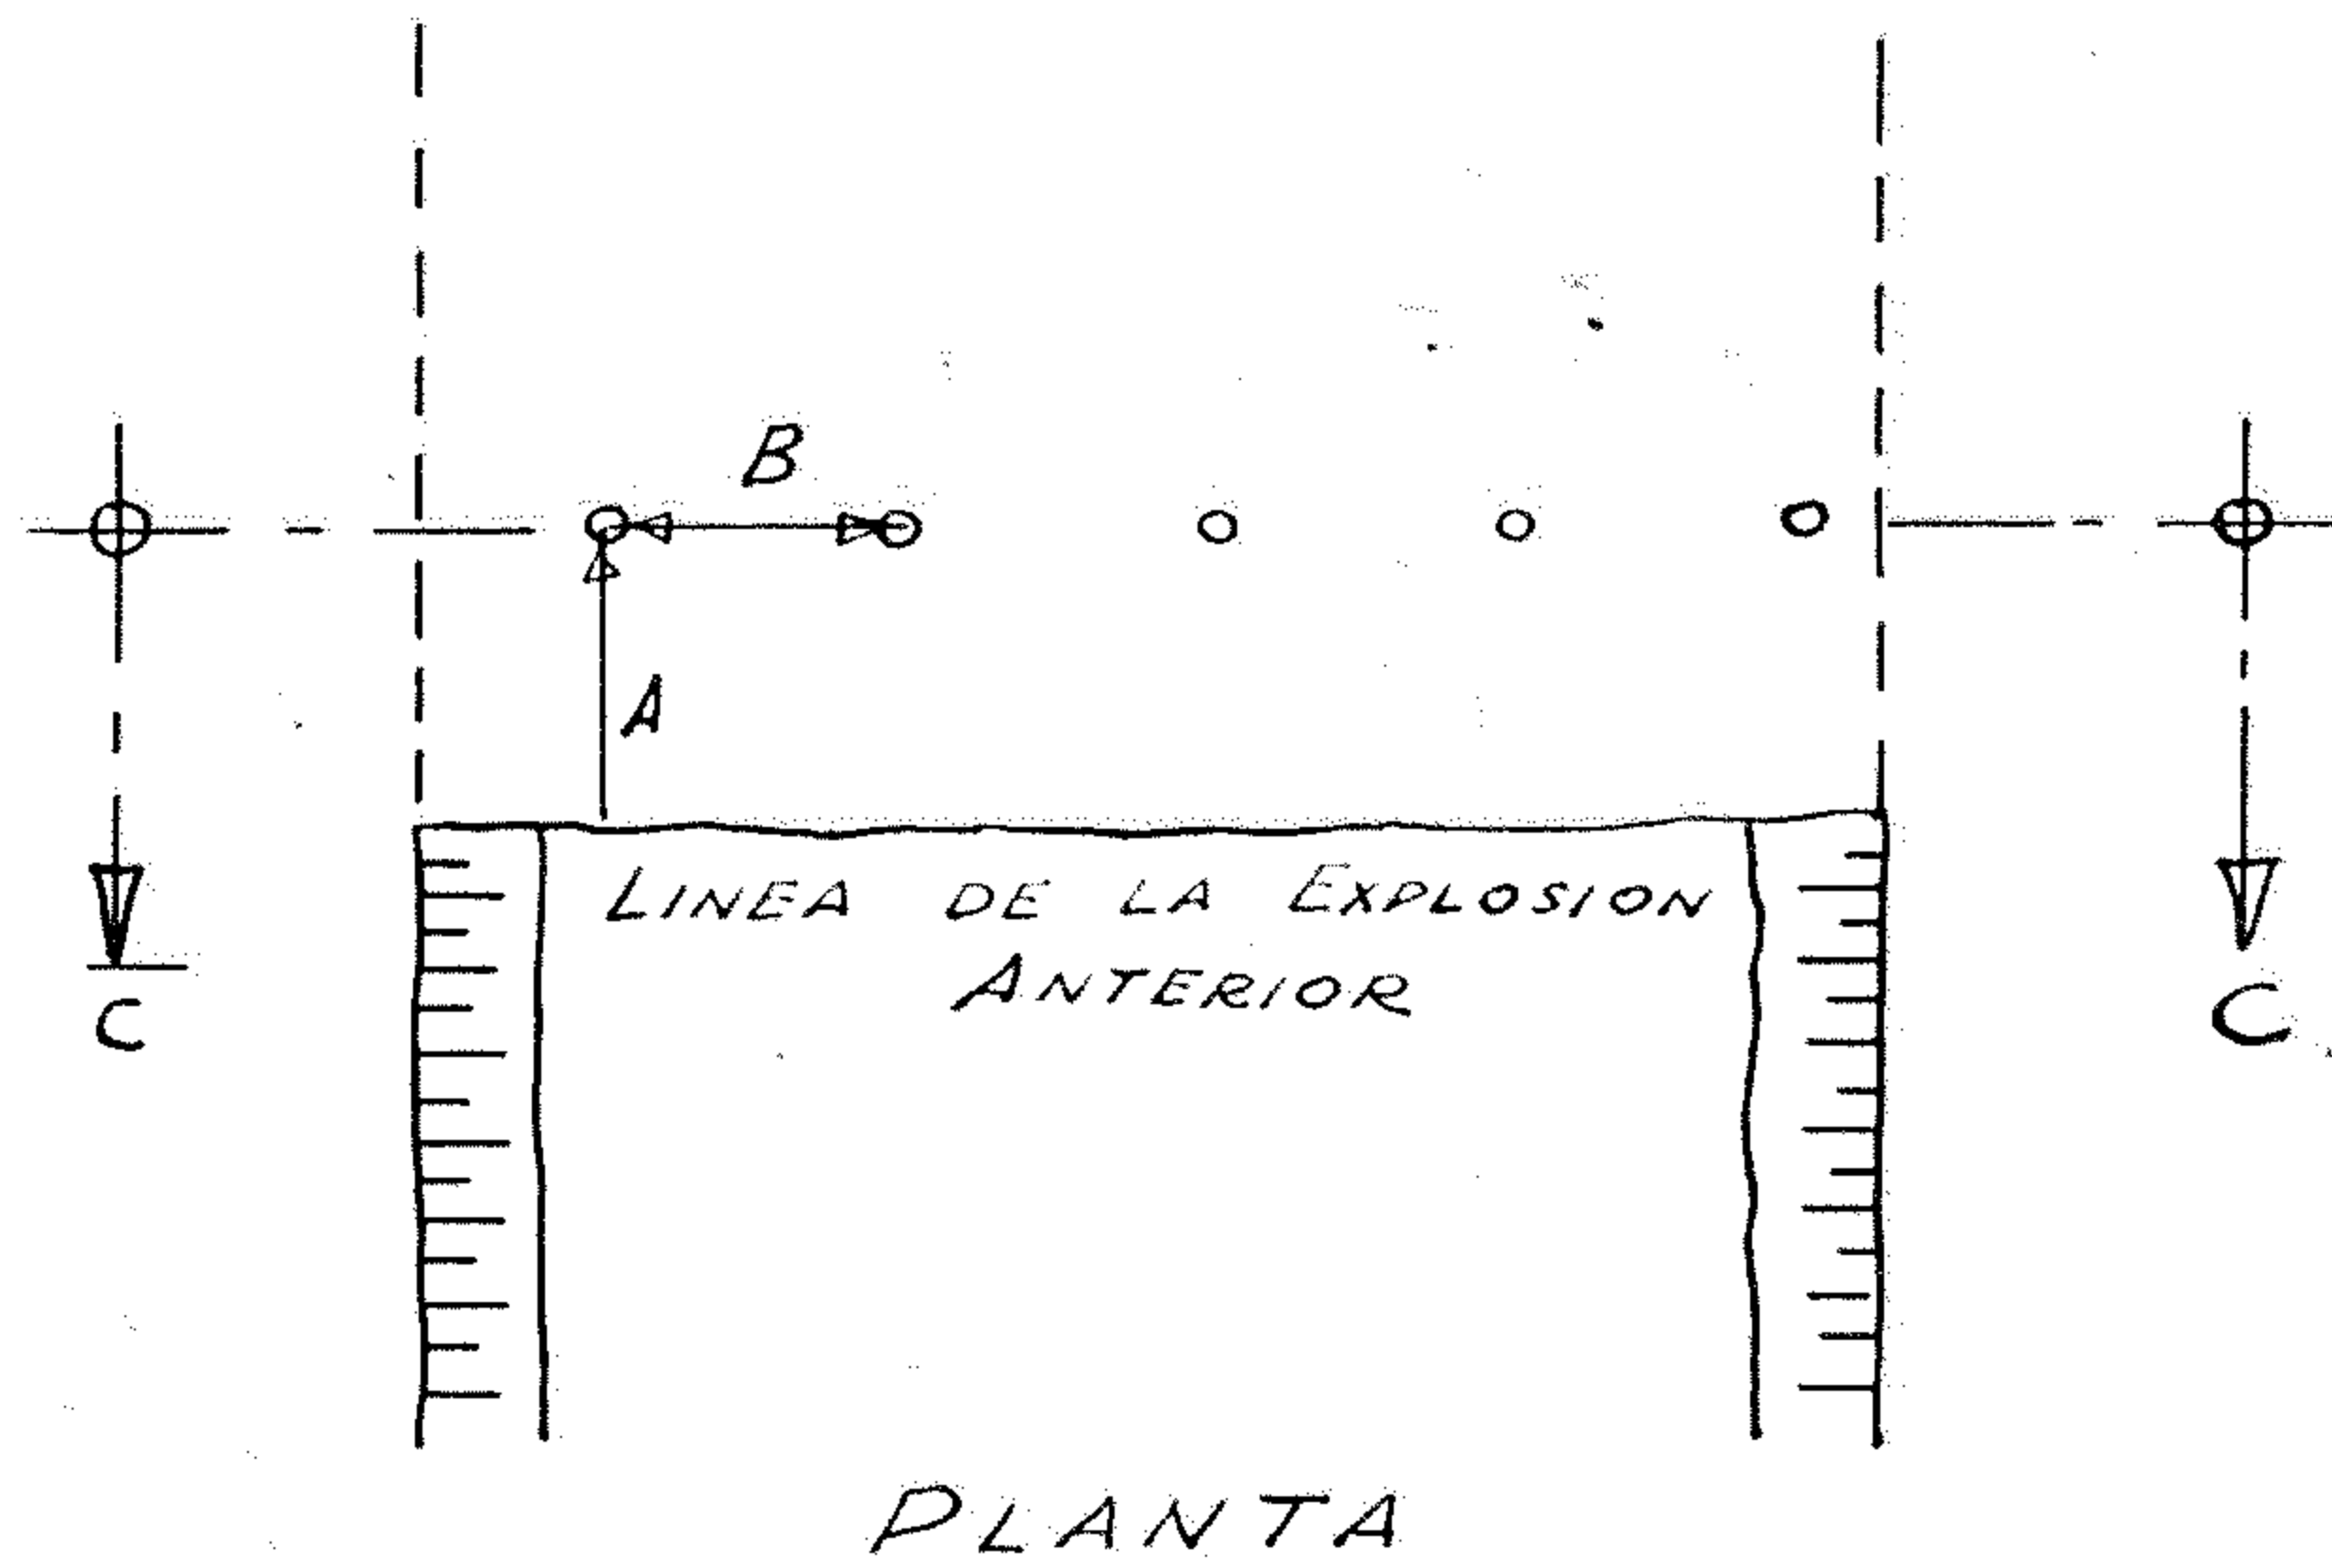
TRABAJO CON DINAMITA EN CORTES CERRADOS
